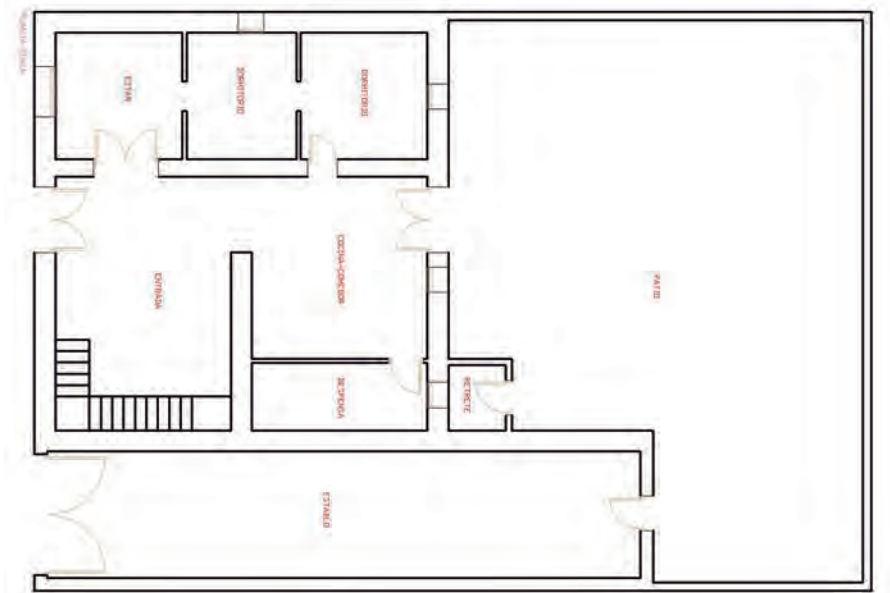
Plano Tipo. Casa-1 planta Baja. Elaborado por Antonio García Hernández.
